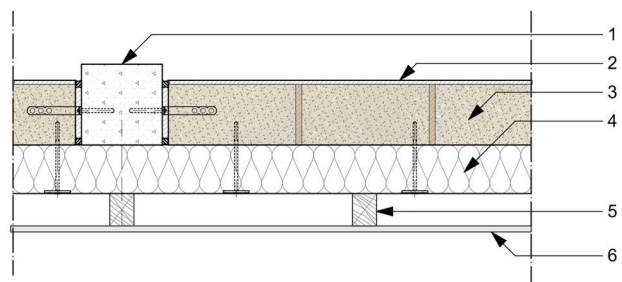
Cas A avec ITE et enduit sur face extérieure de la maçonnerie BTC
